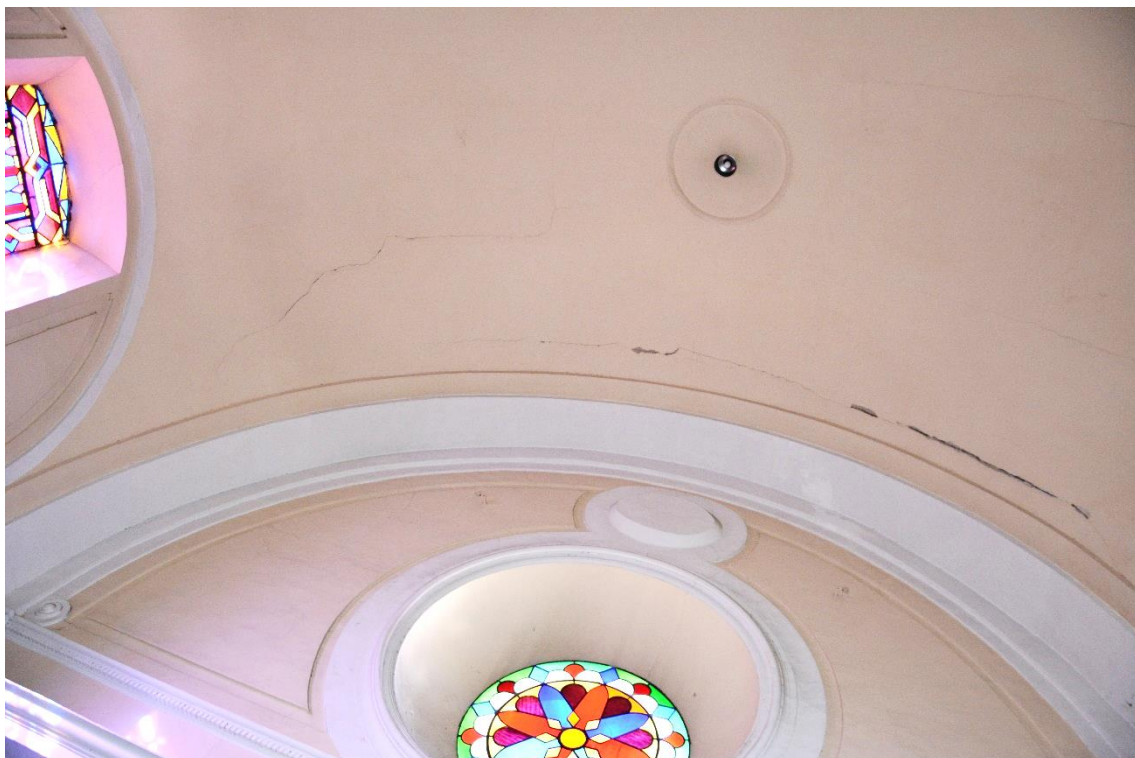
Grietas producidas por el desplome del muro dela fachada principal del templo (fotografía del autor)
